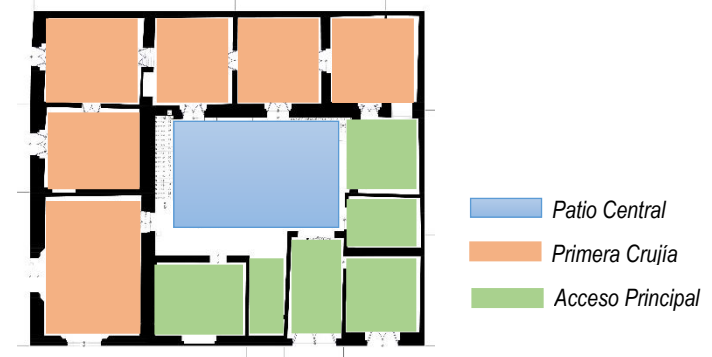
Plano de Planta Baja, variables de funcionamiento.
